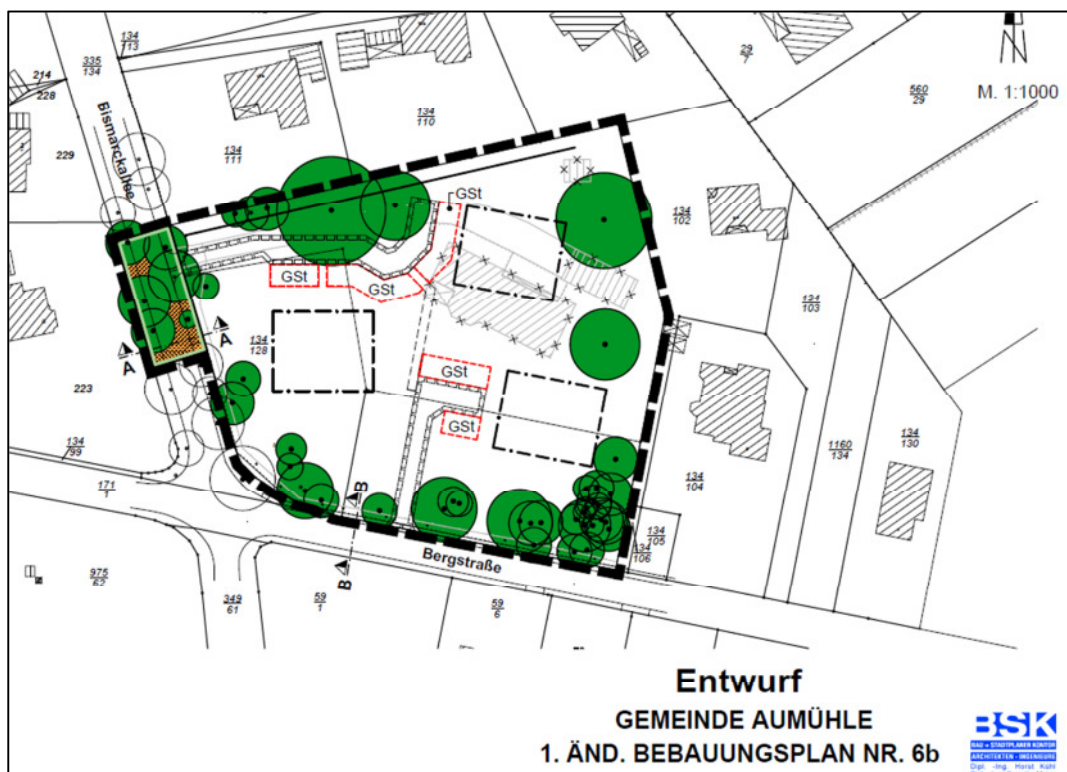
B-Plan Nr. 6b (1. Änderung) der Gemeinde Aumühle (erstellt durch BSK, Stand: 13.1.2016).
